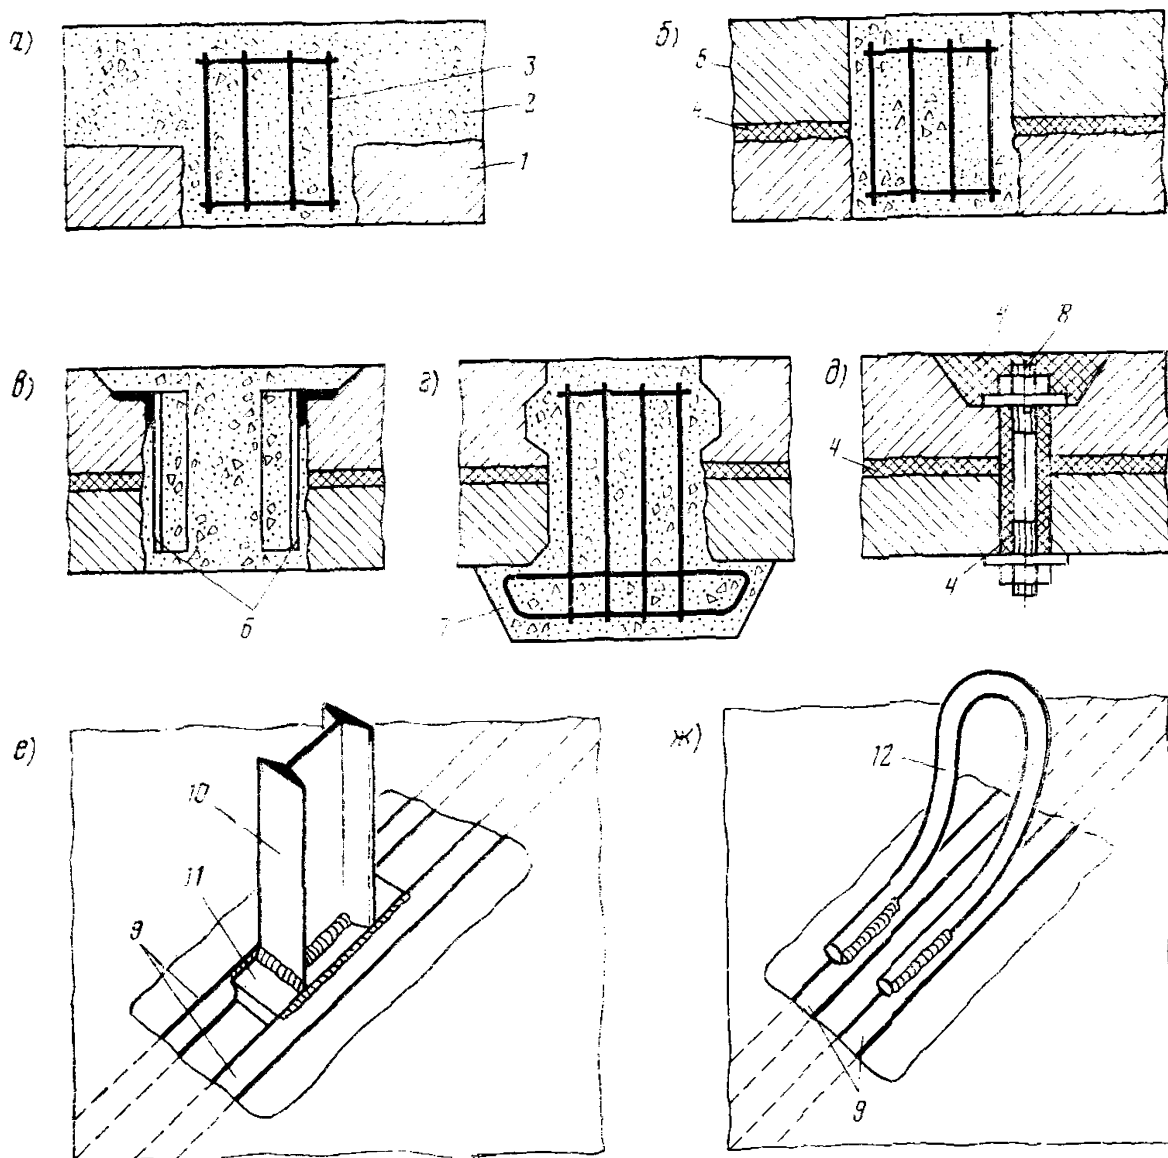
Узлы объединения накладной плиты с существующими балками: а — железобетонная шпонка объединения монолитной накладной плиты; б — бетонная шпонка присоединения сборной накладной плиты, армированная гибкой арматурой; в — то же, армированная жесткой арматурой; г — анкерная шпонка; д — болтовое соединение на высокопрочных болтах; е — жесткий упор; ж — гибкий петлевой анкер; 1 — плита существующих балок; 2 — бетон замоноличивания; 3 — арматурные коротыши; 4 — слой цементного раствора; 5 — сборная накладная плита; 6 — жесткая арматура из профильного металла; 7 — анкерное утолщение шпонки; 8 — высокопрочный болт; 9 — оголенная арматура существующих балок; 10 — жесткий упор; 11 — металлическая пластинка; 12 — петлевой анкер
